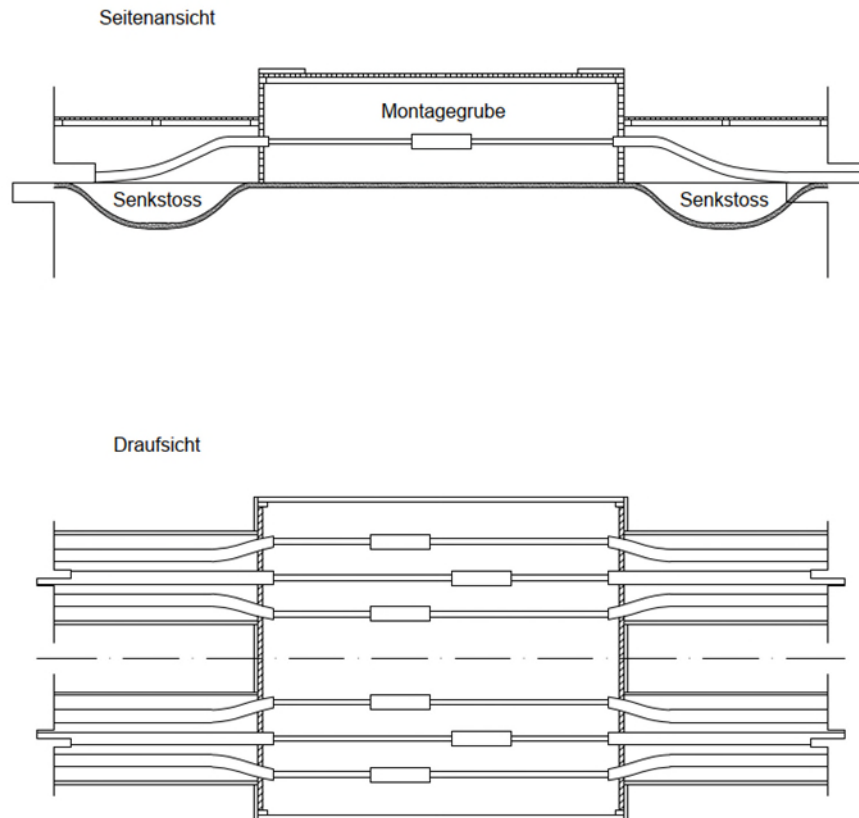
Beispielhafte Prinzipzeichnung einer Muffengrube für 2 Systeme
